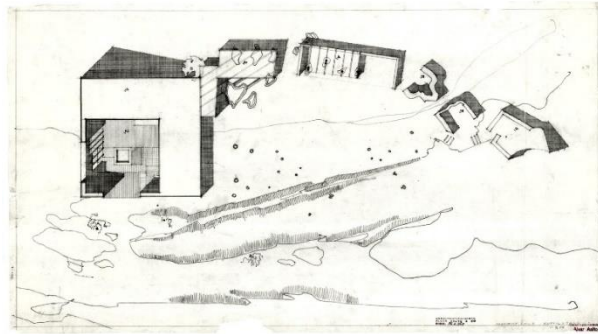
Planta de Muuratsalo. Alvar Aalto.
